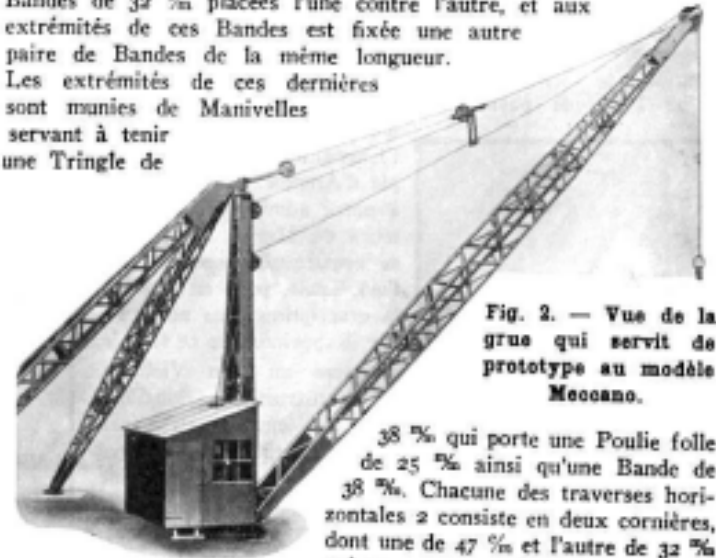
Vue de la grue qui sert de prototype au modèle Meccano.
